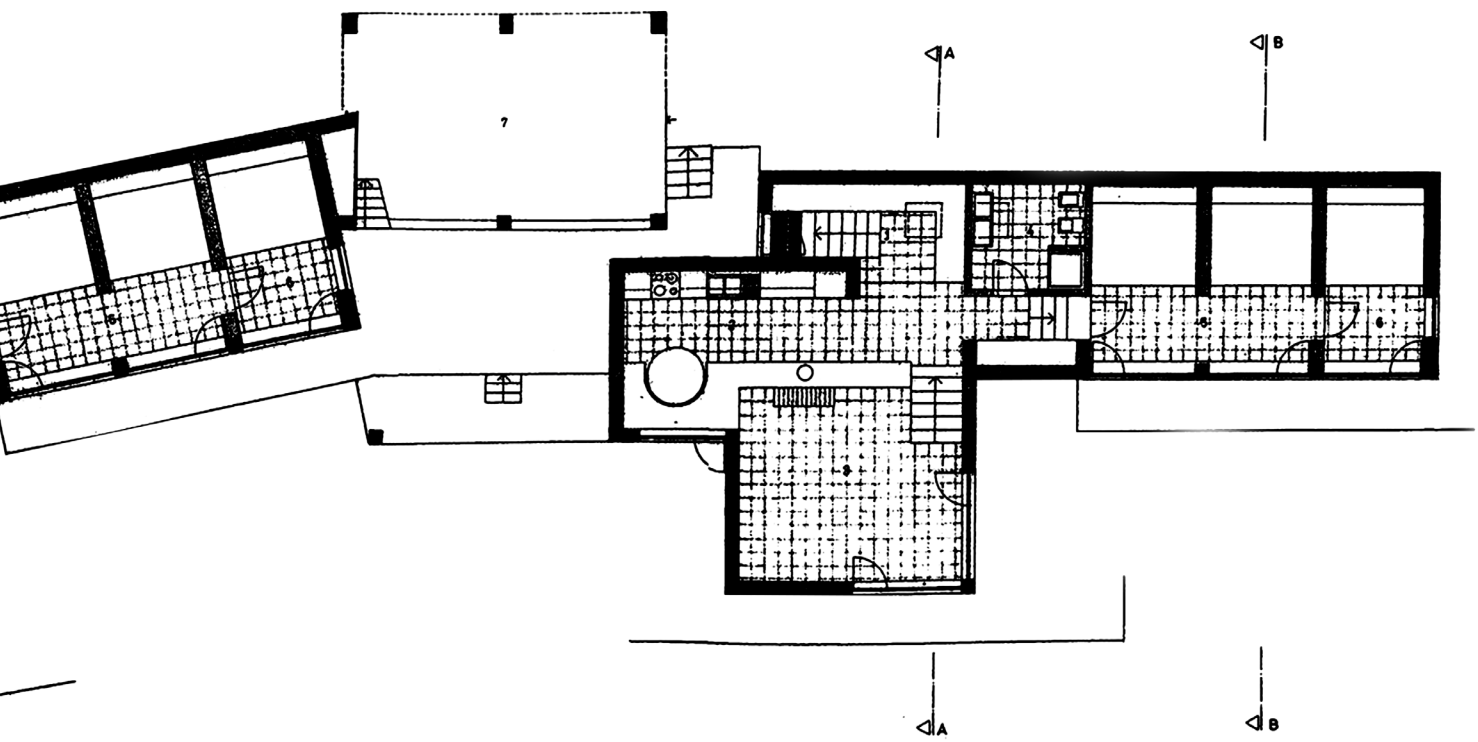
Em cima - ao centro: Vill'Alcina - Planta
